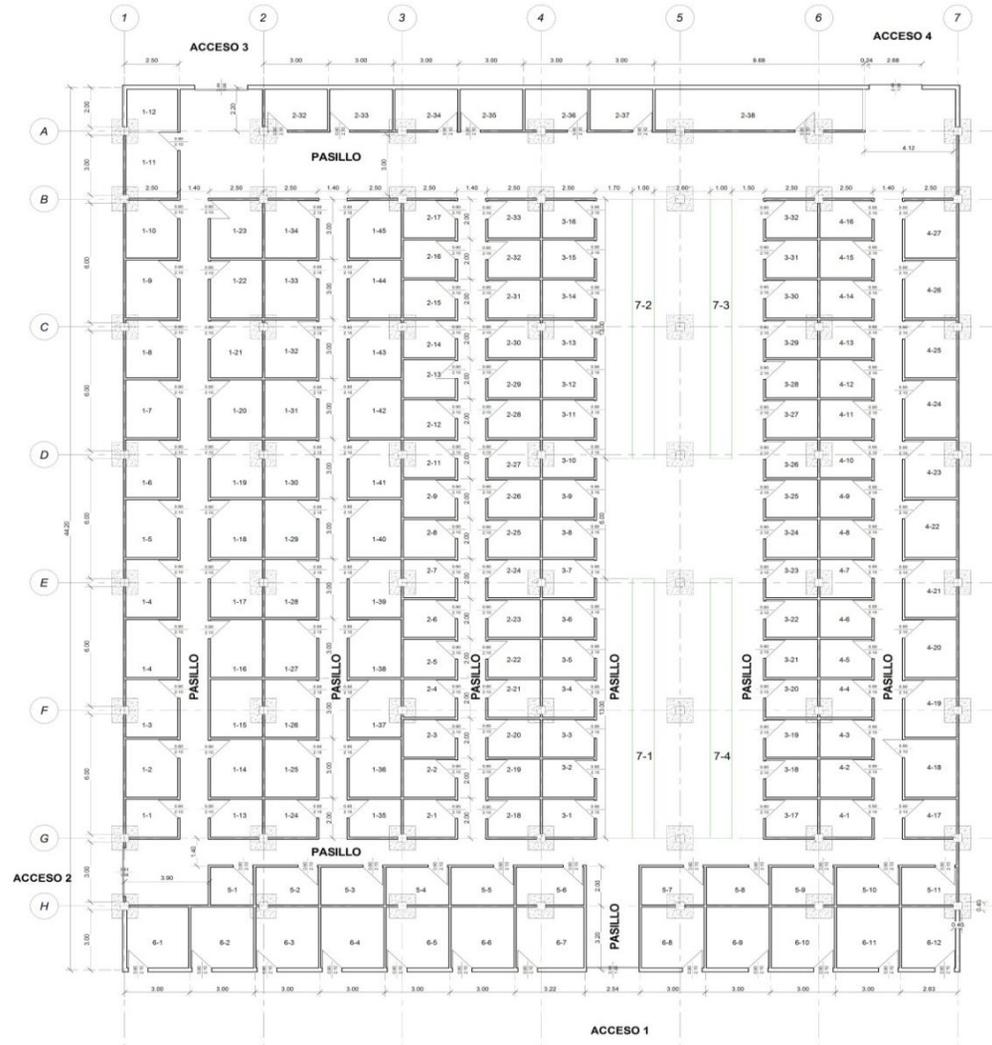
Puesto de Mercado en la 1ª avenida Norte
